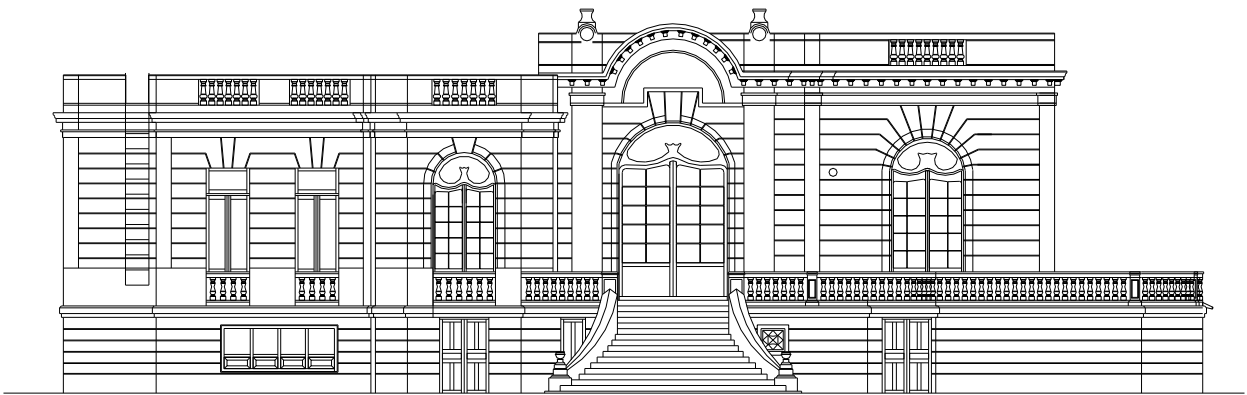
Fachada Principal Poniente, Proyecto de Restauración de la Casa del Lago.
